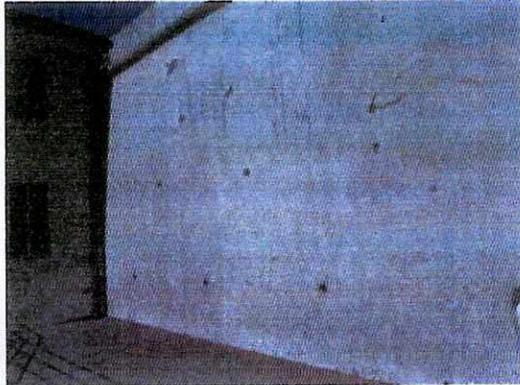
Humedad en muro colindante con predio utilizado como parqueadero posterior al Teatro Capitol
